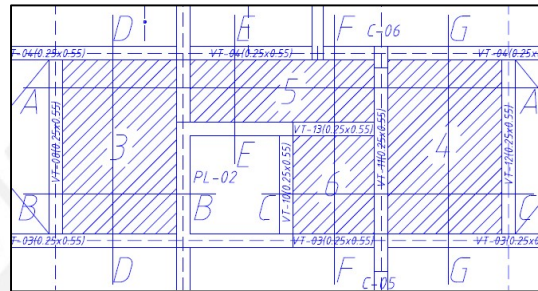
Plano en planta losa maciza Eje B-E/4-5
